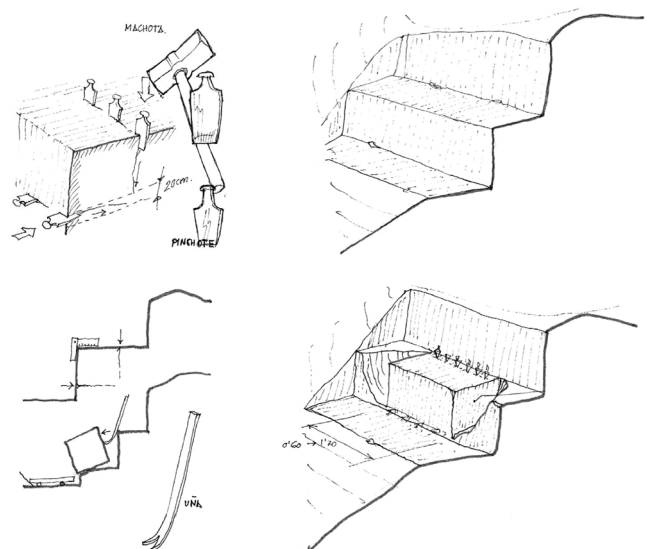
Sistema de extracción de bloque de piedra en cantera. Elaboración propia.
